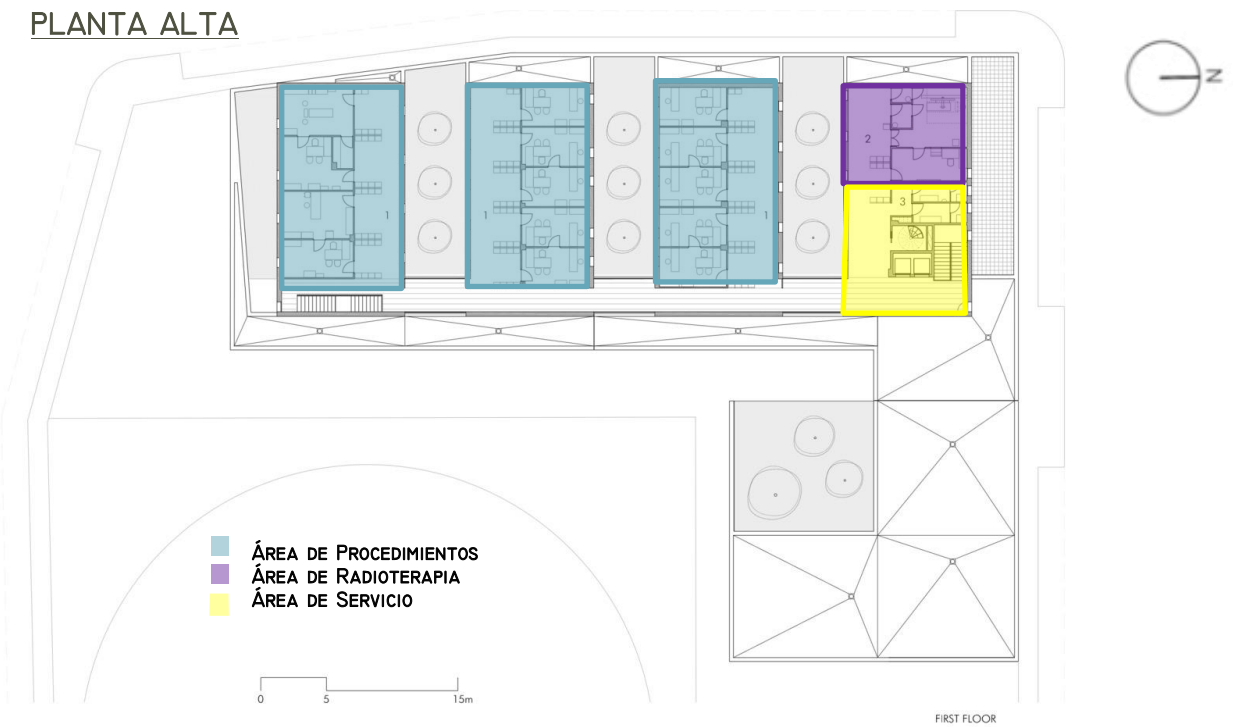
Plantas arquitectónicas de Centro de Salud de Gibraleón, España
